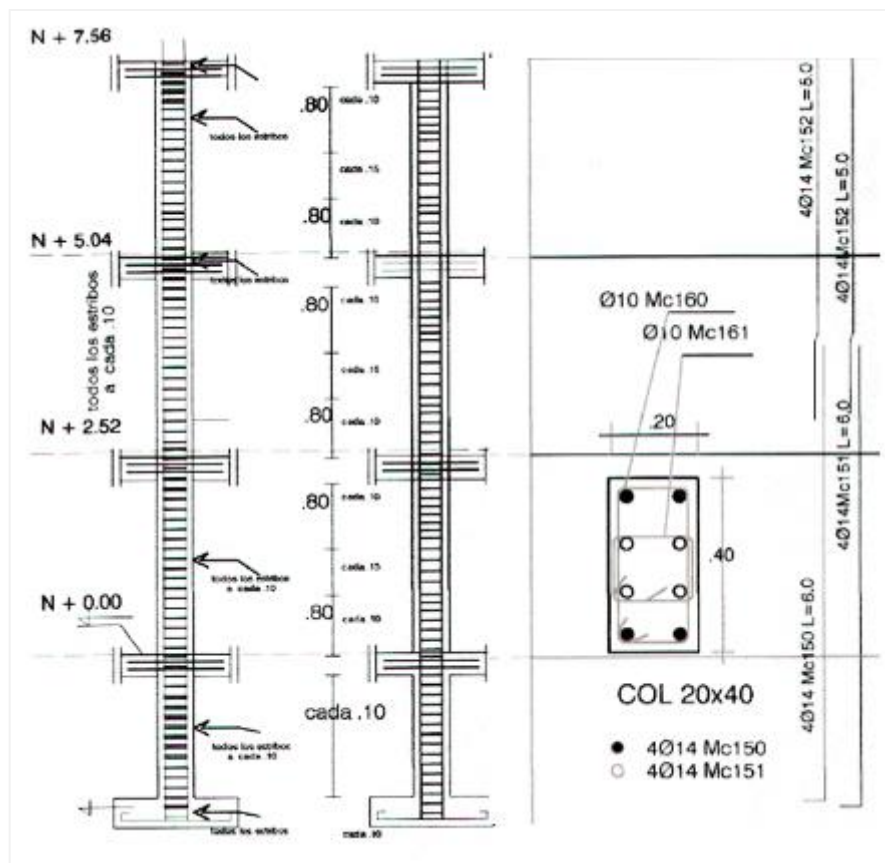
Esquema de distribución de acero en columnas. Casa C41-P9
